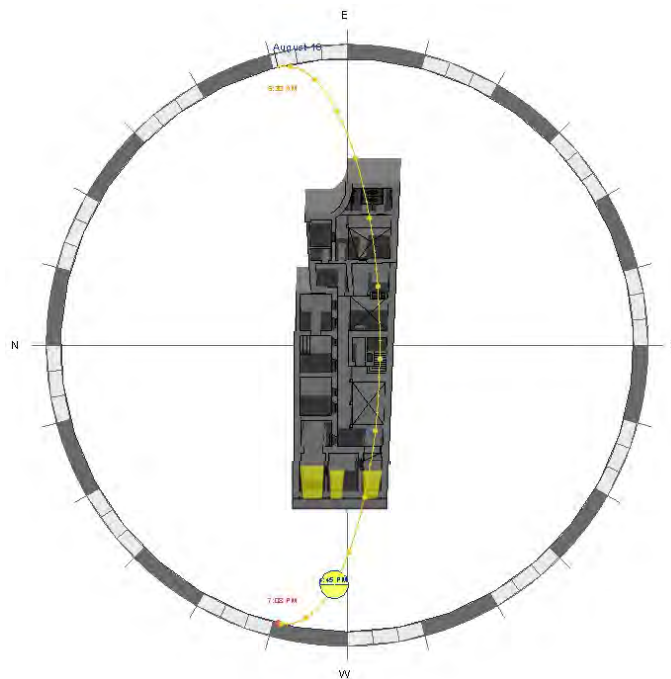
Incidencia de la luz cenital en la planta baja del inmueble. El sol en la fachada poniente. Elaboró: METR
